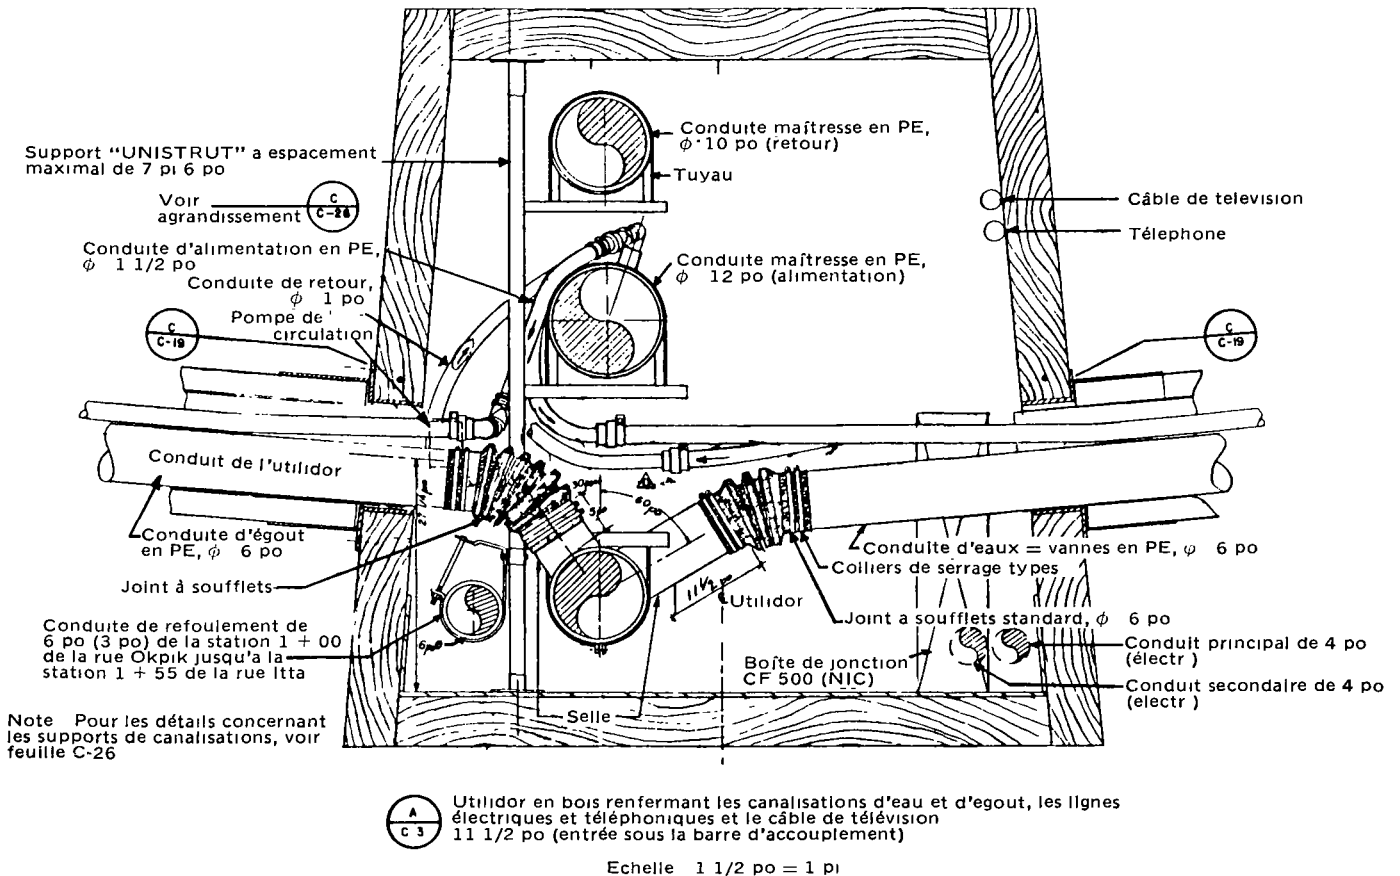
SECTION TYPE DE L'UTILIDOR
